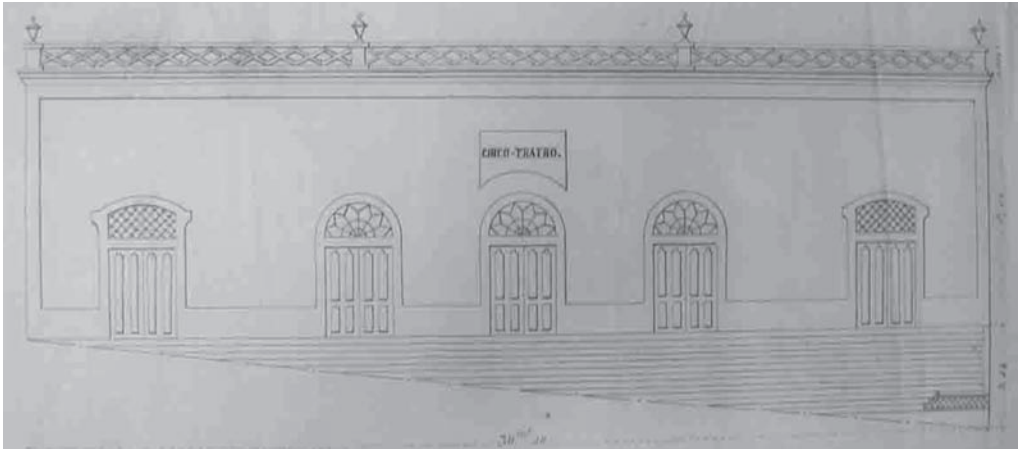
Segundo proyecto para la fachada del *Tamberlick*. D.R. Sesmero. 1882.
